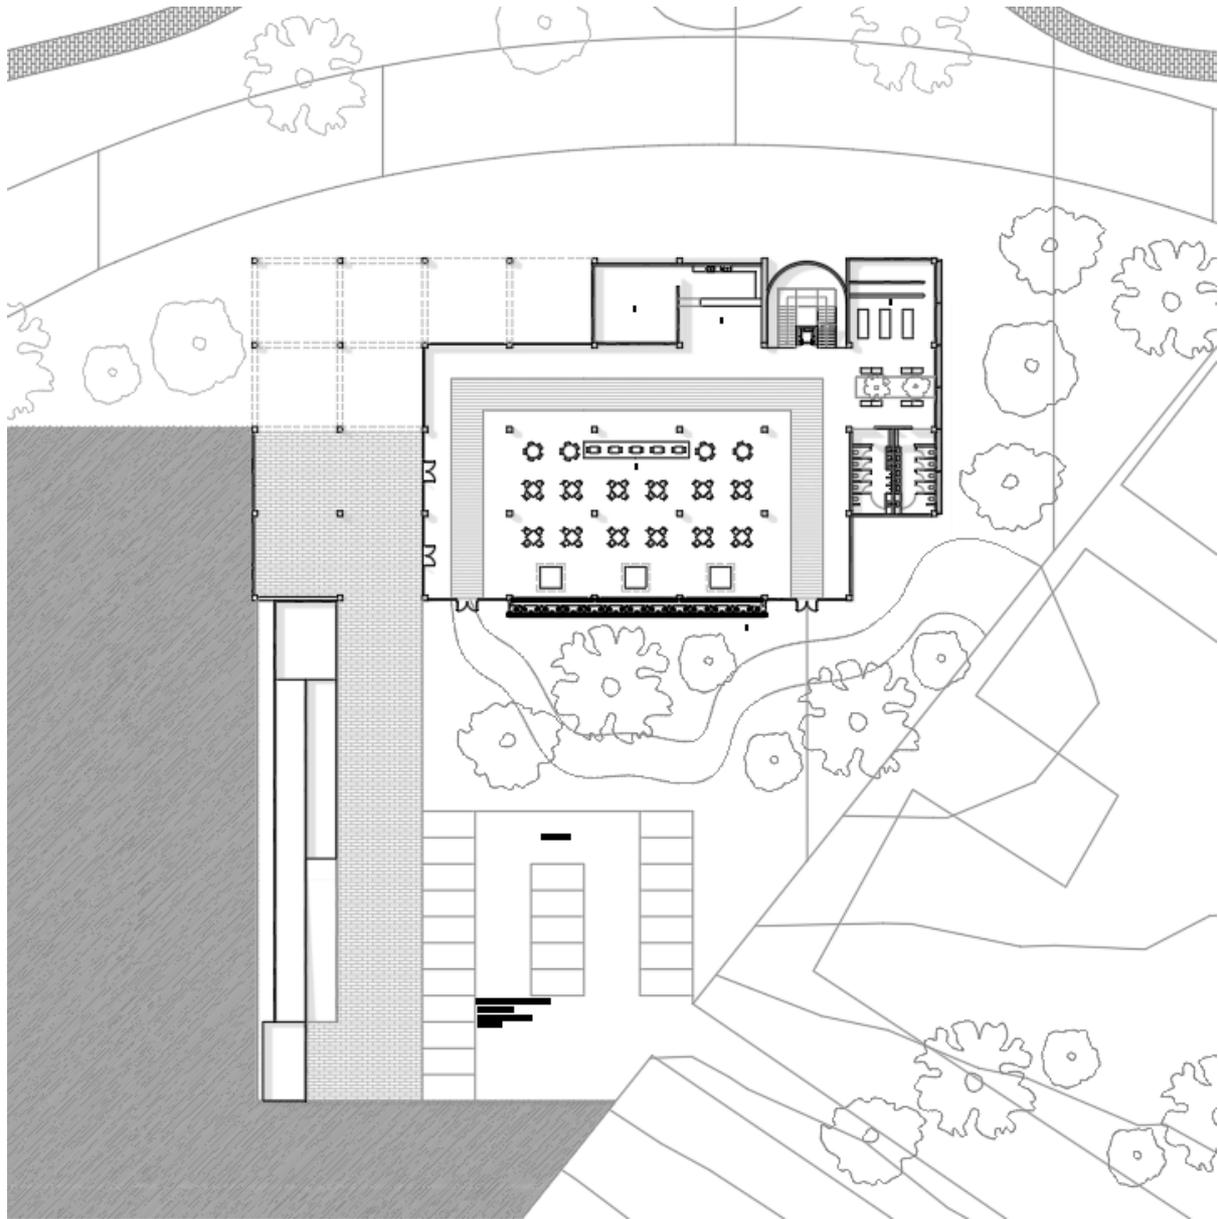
Planta baja nivel -5.00m. Elaboración propia
